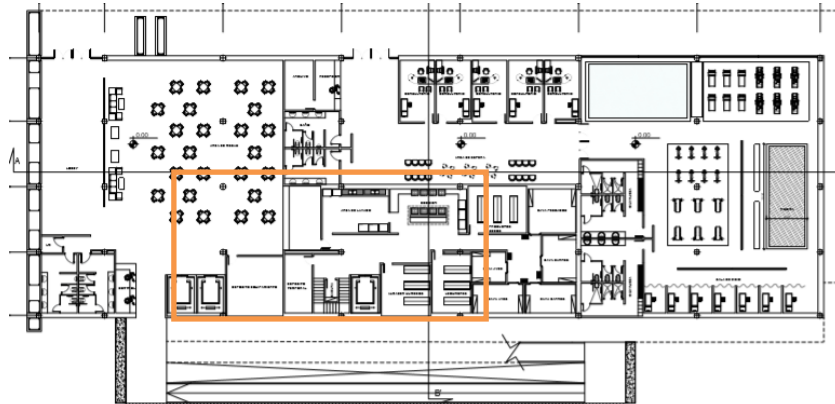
Planta Baja. Servicios. Nivel +0,00m. (2020)
